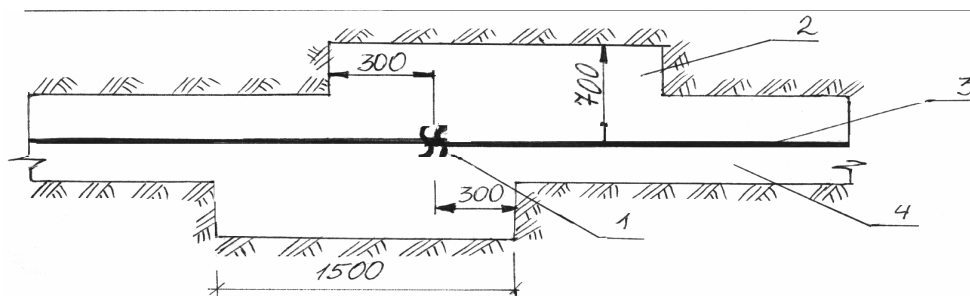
Приямок для сварки неповоротных стыков:
